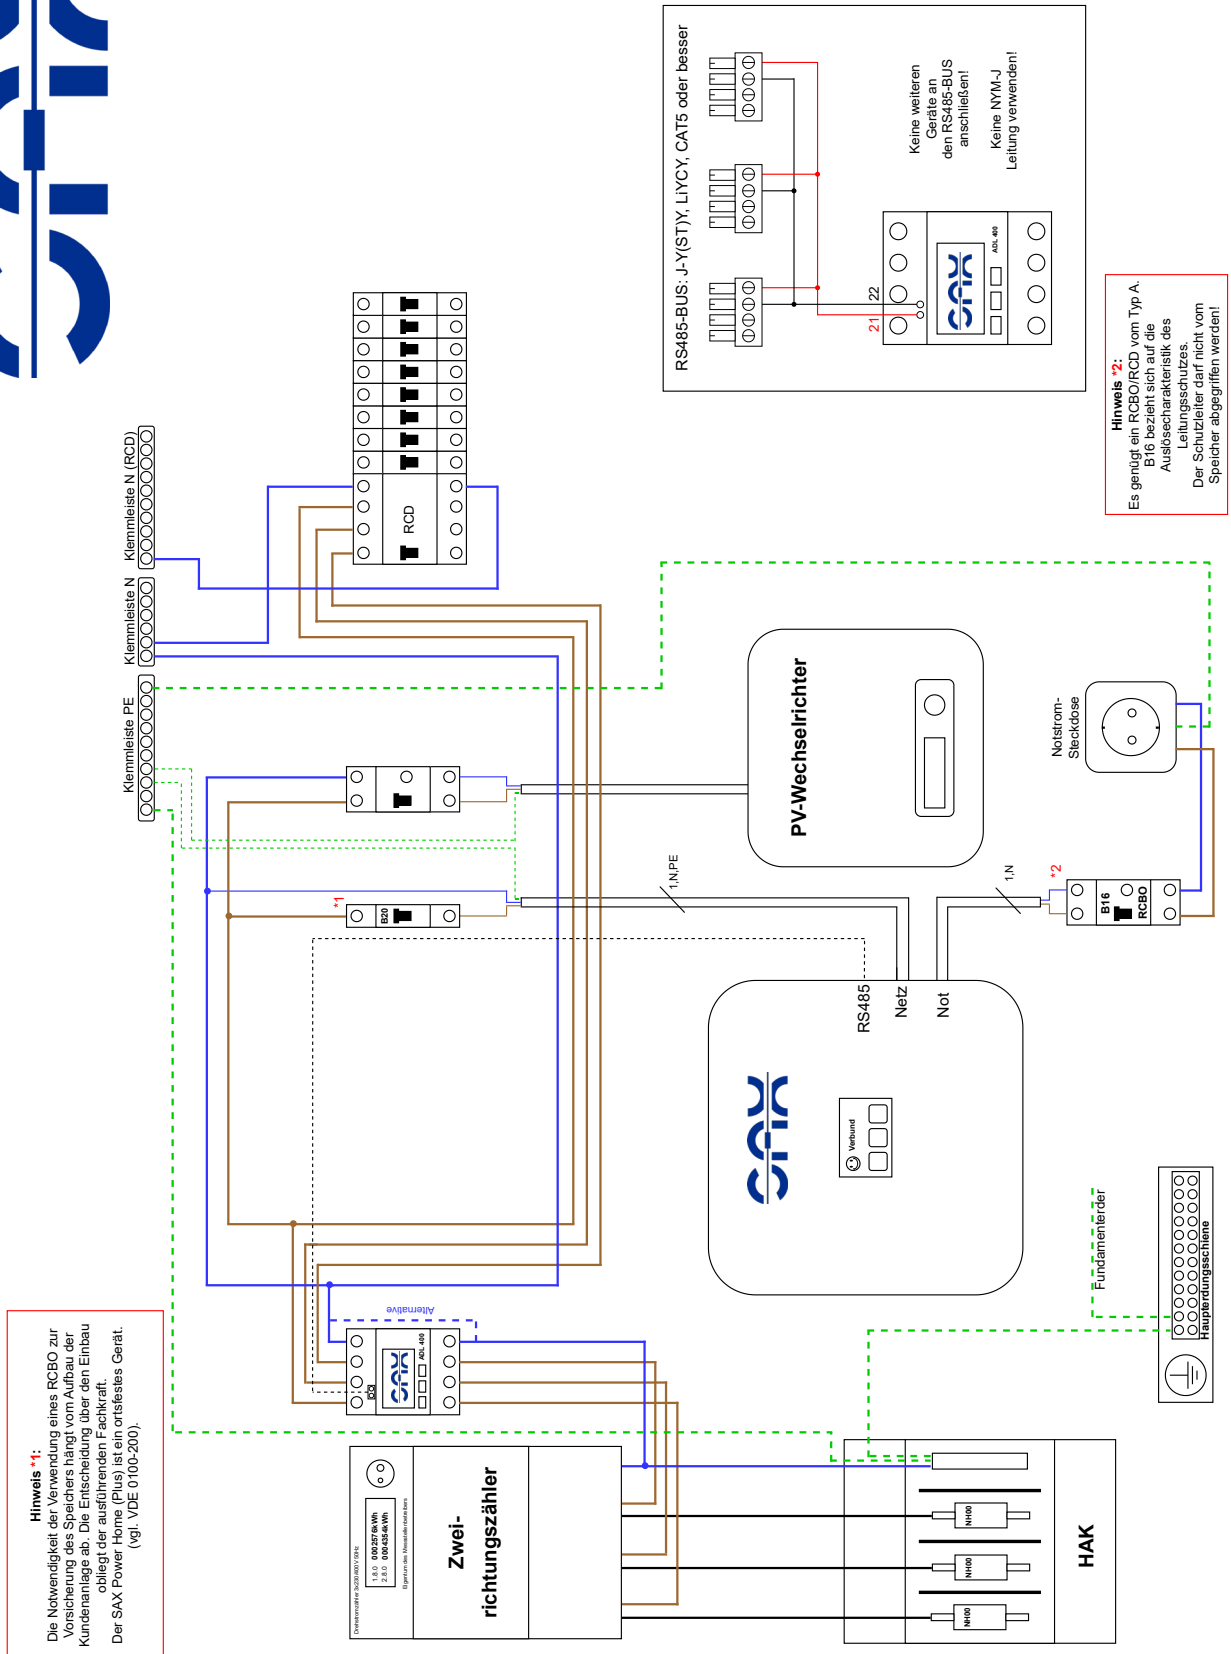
Anschlussschema mit ADL400 (Standardinstallation)
